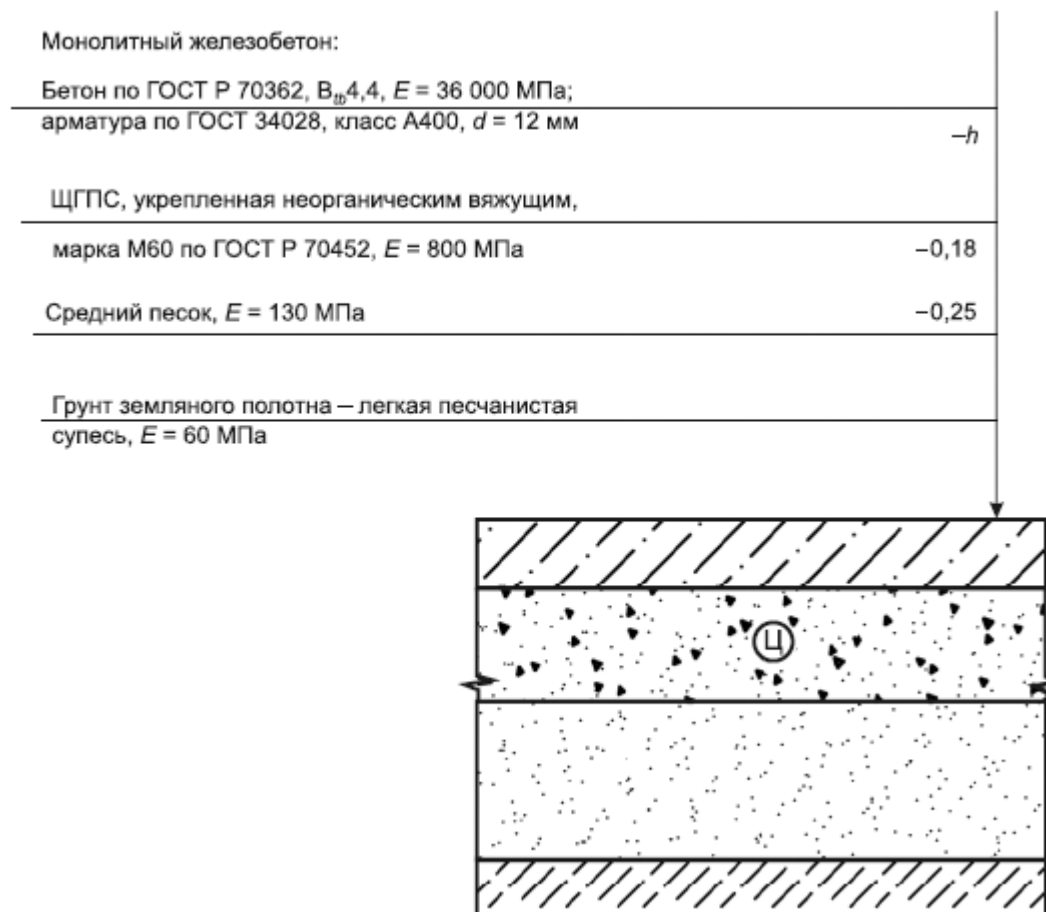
Конструктивный разрез проектируемой дорожной одежды с монолитным железобетонным покрытием
